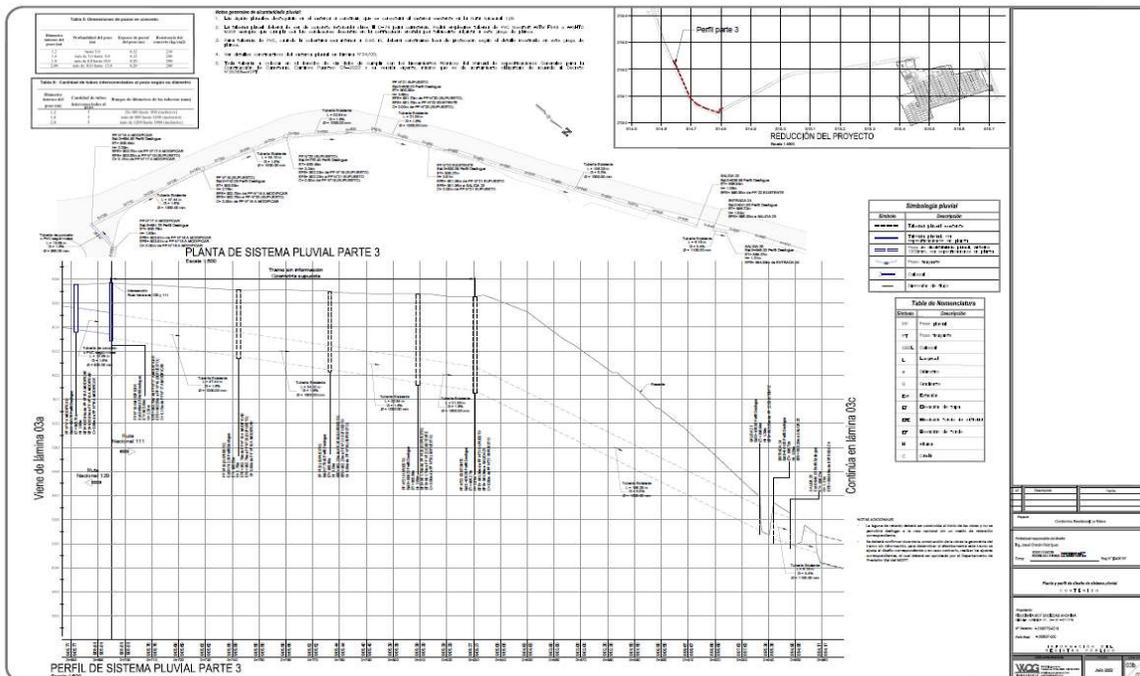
Trayecto de Tubería Pluvial sobre Ruta Nacional # 129, descarga en Río Segundo. (trayecto # III). Lámina Pluvial # 03c
